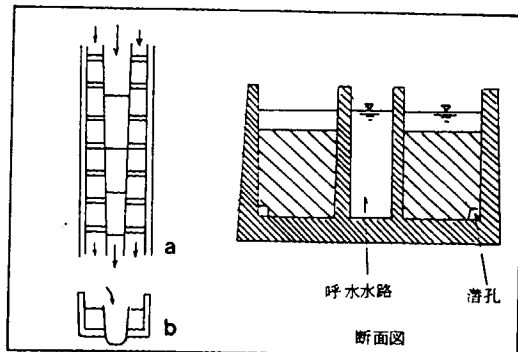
よび水式魚道 (a : 平面図, b : 上流側からの正面図) (小山, 1967)
